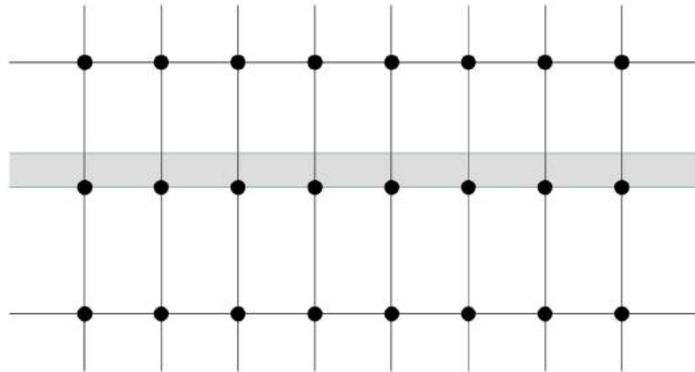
Systemgrundriss, Mittelflur und ungleiche Raumtiefen
